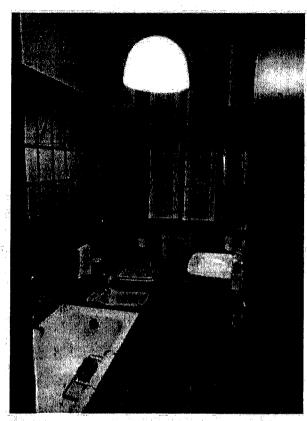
e 105 - Rilievo interno - Il locale camera letto a Sud-Ovest
